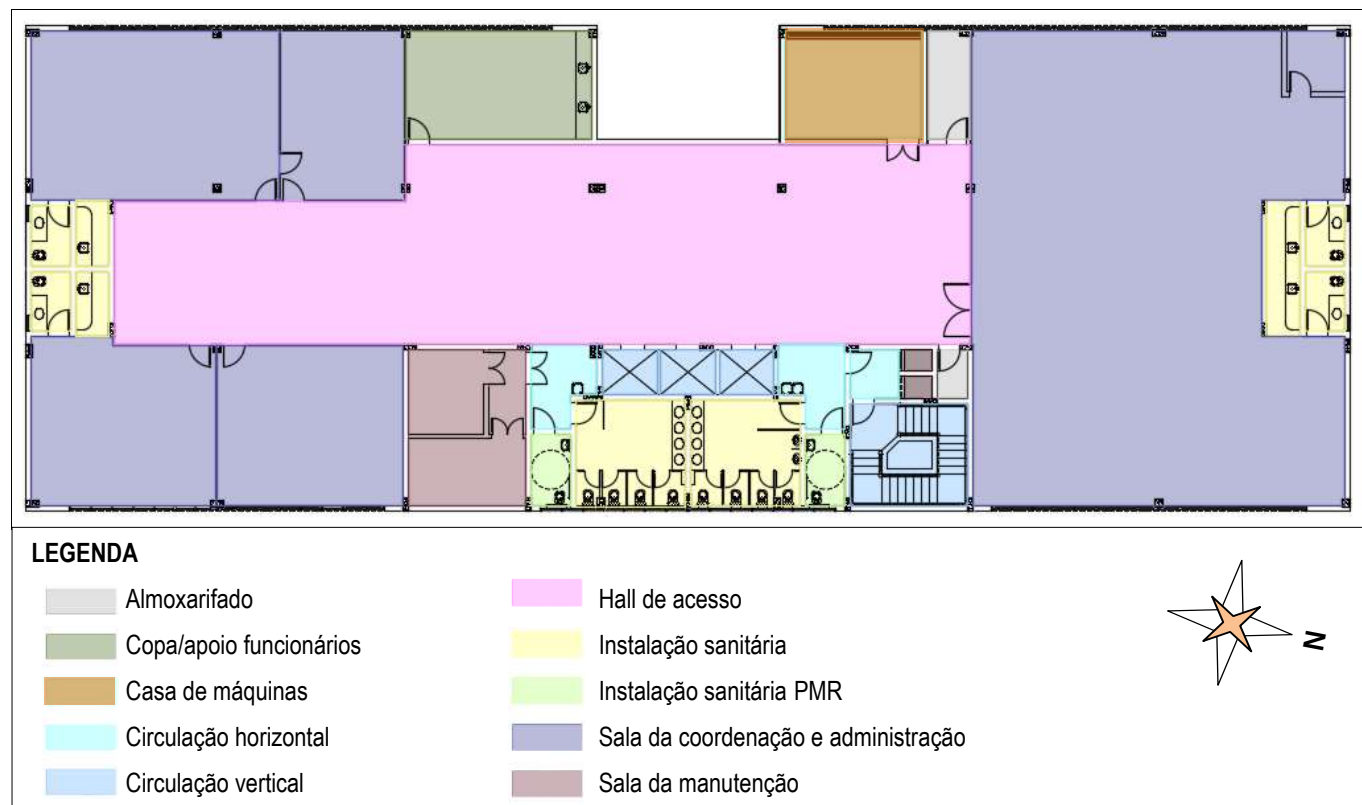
Planta setorizada do quinto pavimento do bloco 02.
